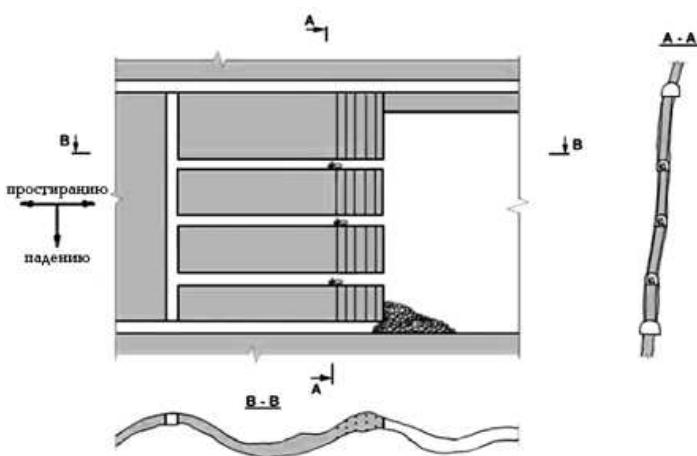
Система разработки с открытым очистным пространством и отбойкой руды из горизонтальных буровых выработок
